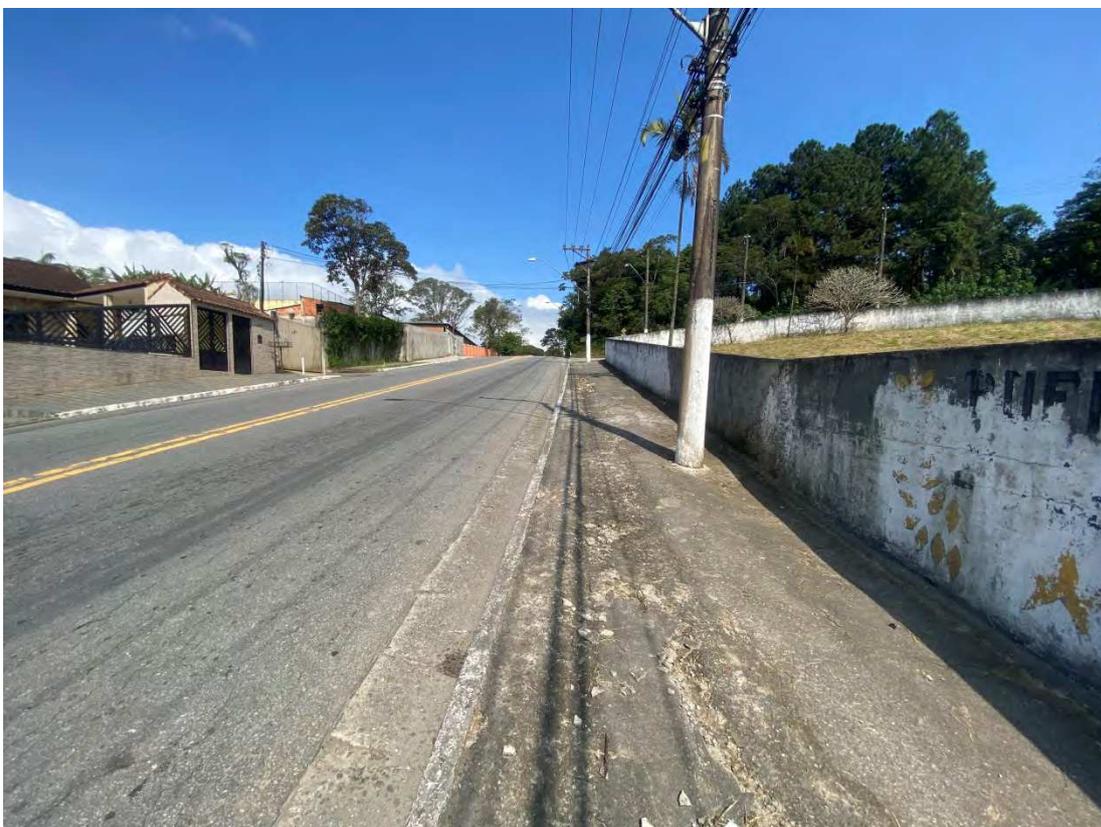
Vista da Estrada do Rio Acima sentido sudoeste.
